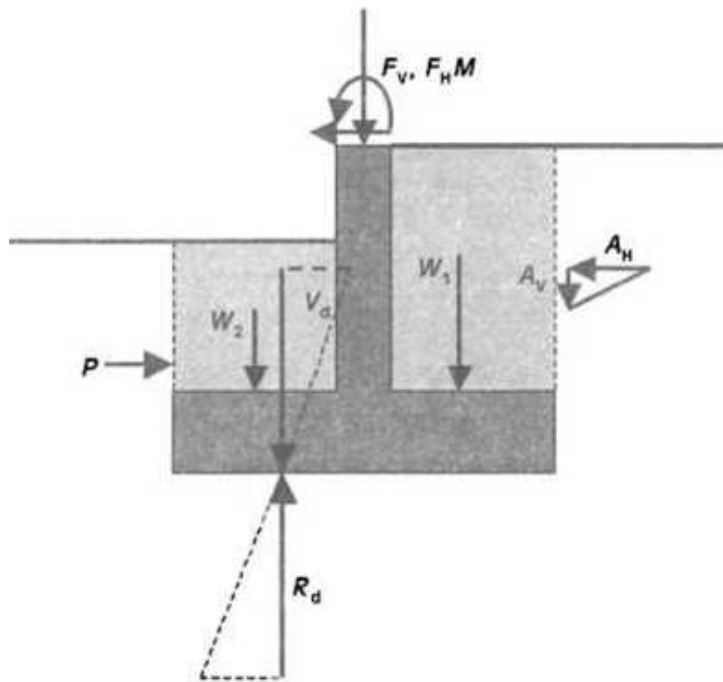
Приклад впливу на фундамент: V_d – складова рівнодіючої, перпендикулярна до фундаменту; H , M і V – впливи від конструкції; A і P – тиск ґрунту; W_1/W_2 – вага ґрунту зворотної засипки
